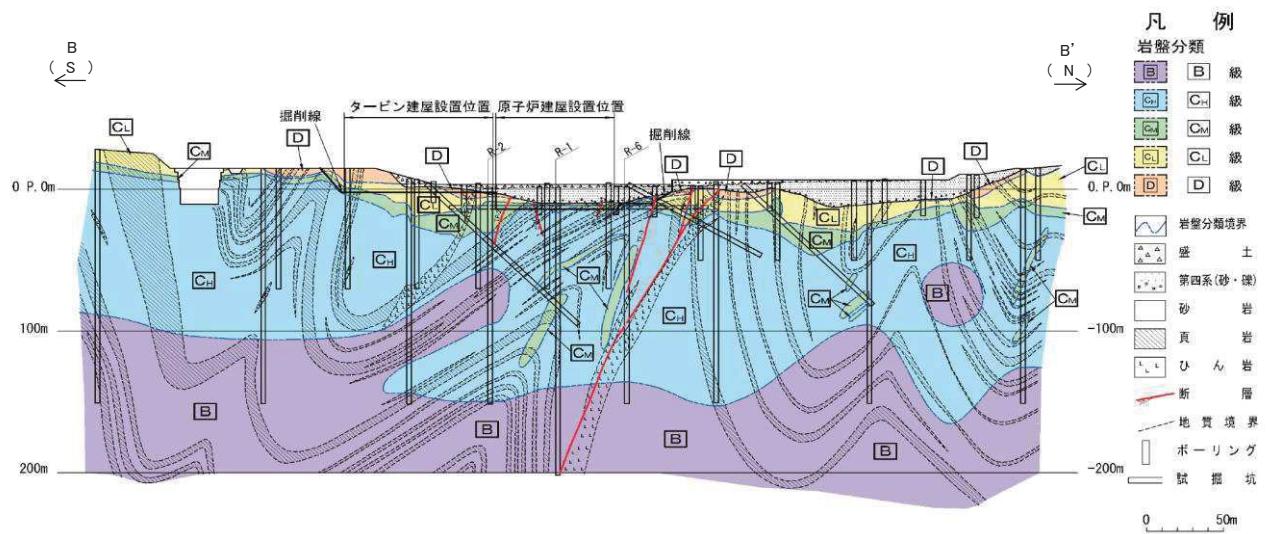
地質断面図 (第 2 号機原子炉建屋中央, 南北方向) (B-B' 断面)
